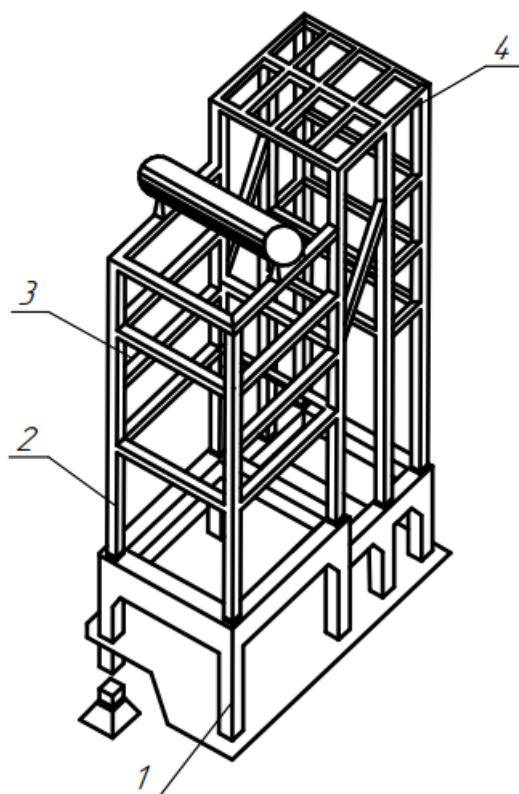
Каркас котла: 1 – фундамент; 2 – несуча колона; 3 – зв'язки ; 4 – балка
